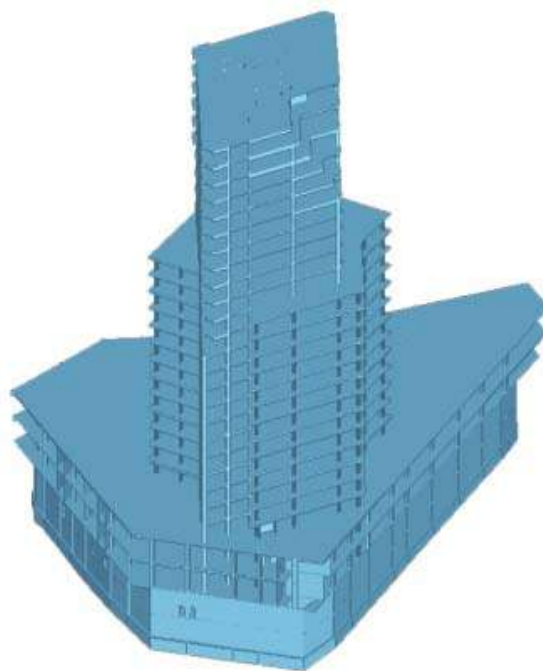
Модель железобетонного каркаса высотного здания сложной геометрической формы в ПК «МОНОМАХ-САПР»
